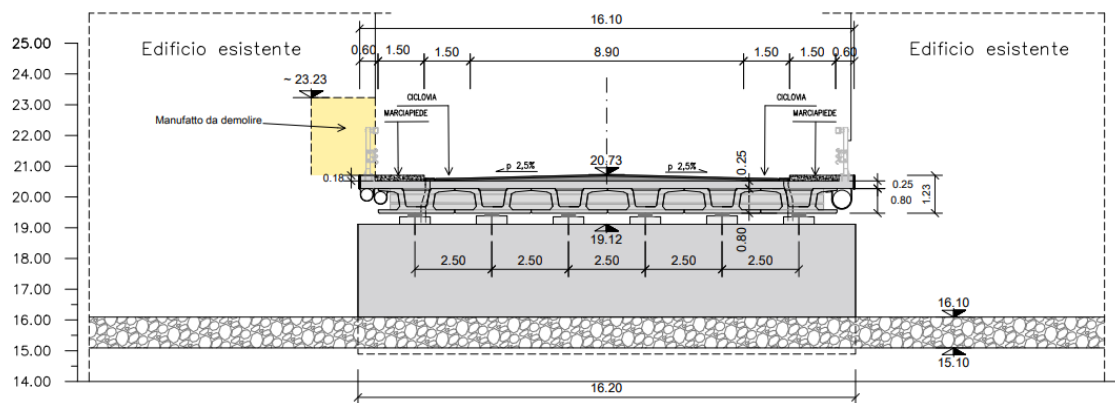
Sezione trasversale del nuovo ponte (in corrispondenza con la spalla nord)
